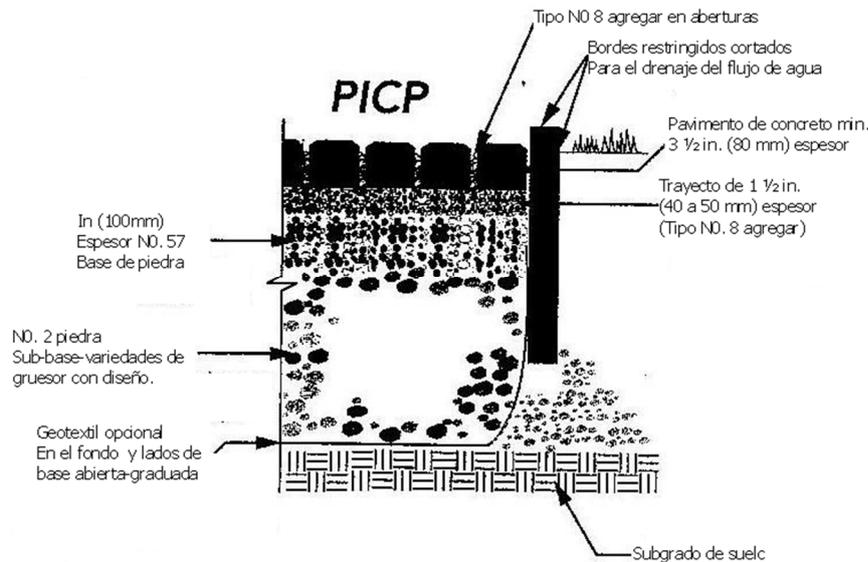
Sistema de pavimento de concreto permeable entrelazado (PICP)
